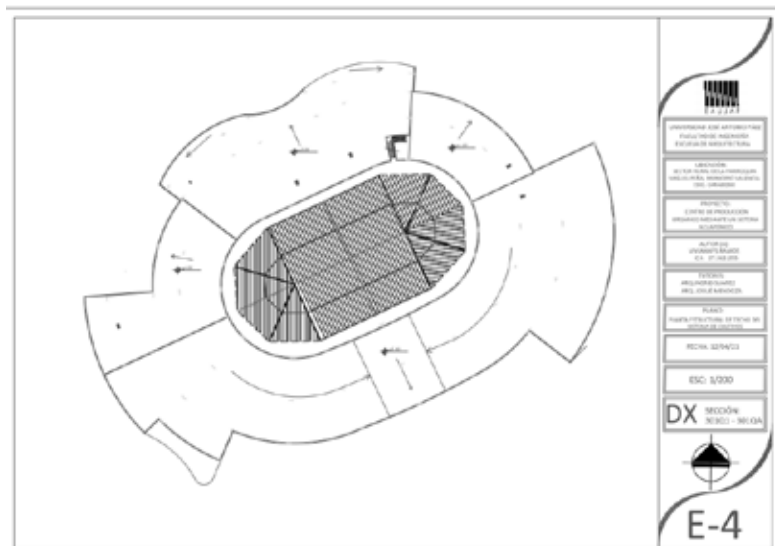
Plano Estructural de Techo del Sistema de Cultivos. Fuente: Presente Autora (2021)
